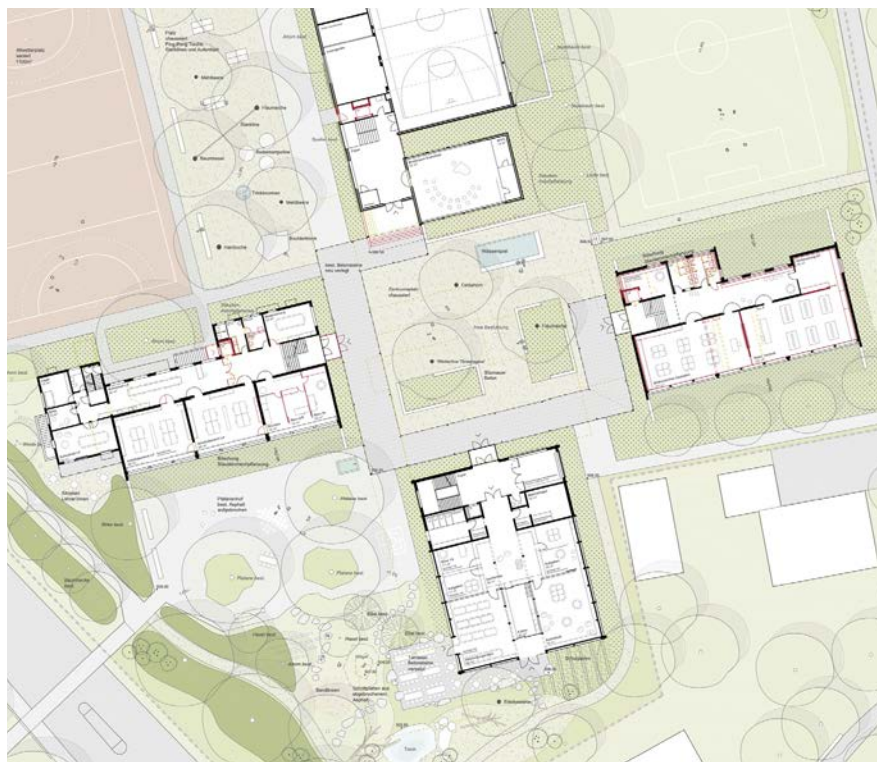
Schlussabgabe, Grundriss Erdgeschoss des Teams 4 Bürgi Schärer
